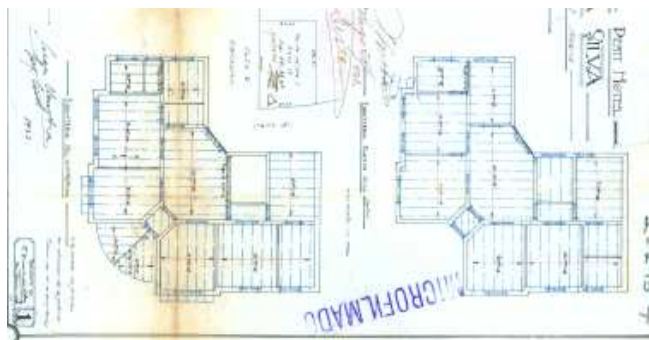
detalle de estructura. Exp. D-42-1923 “Da Silva presenta obra a construir” en Archivo de Obras Particulares Municipalidad de La Plata.
